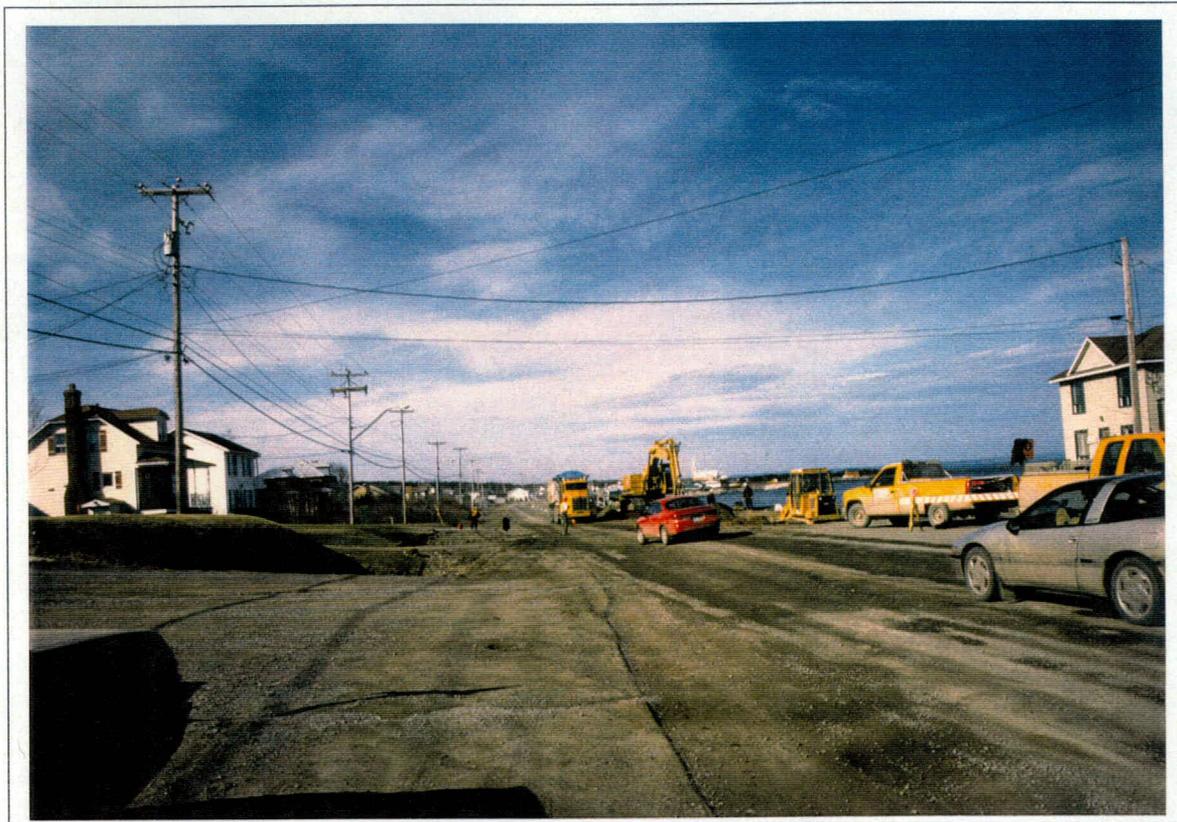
Projet 3172-7803, route 132, secteur 1, au chaînage 1+ 460 (N-E).
